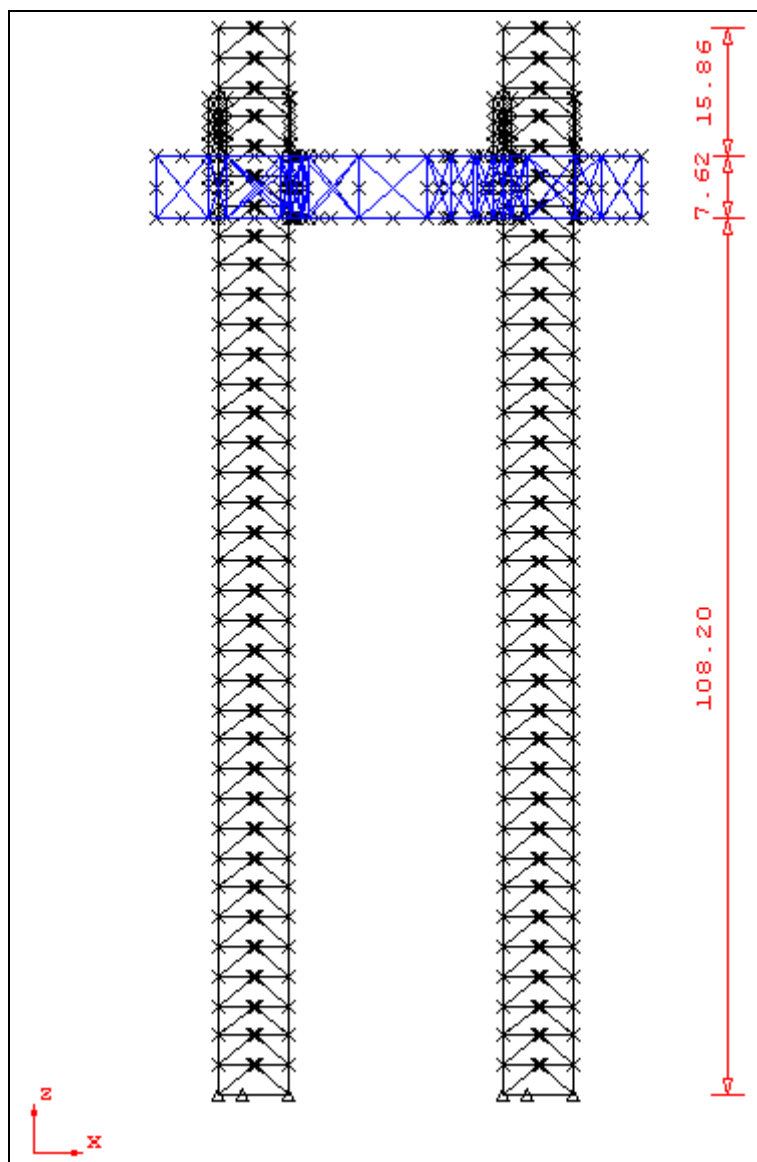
Elevação da plataforma (dimensões em metros)
